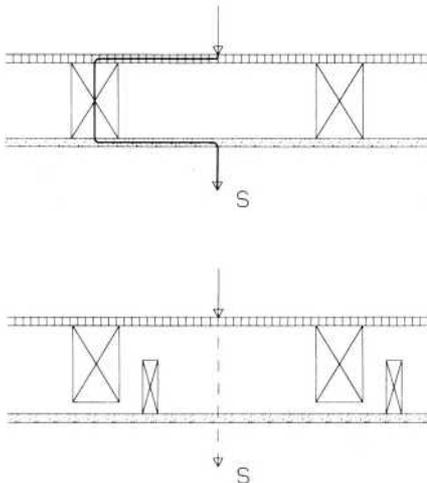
Schallfluß durch den Deckenkasten einer Holzbalkendecke bei einer starr montierten Unterdecke (oben) und bei einer Decke mit entkoppelter Unterdecke (unten)
